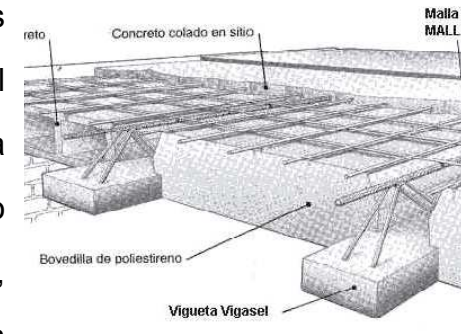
Losa de vigueta y casetón. Fuente: <http://www.armasel.com.mx/imagen/DIAGRAM.jpg>
